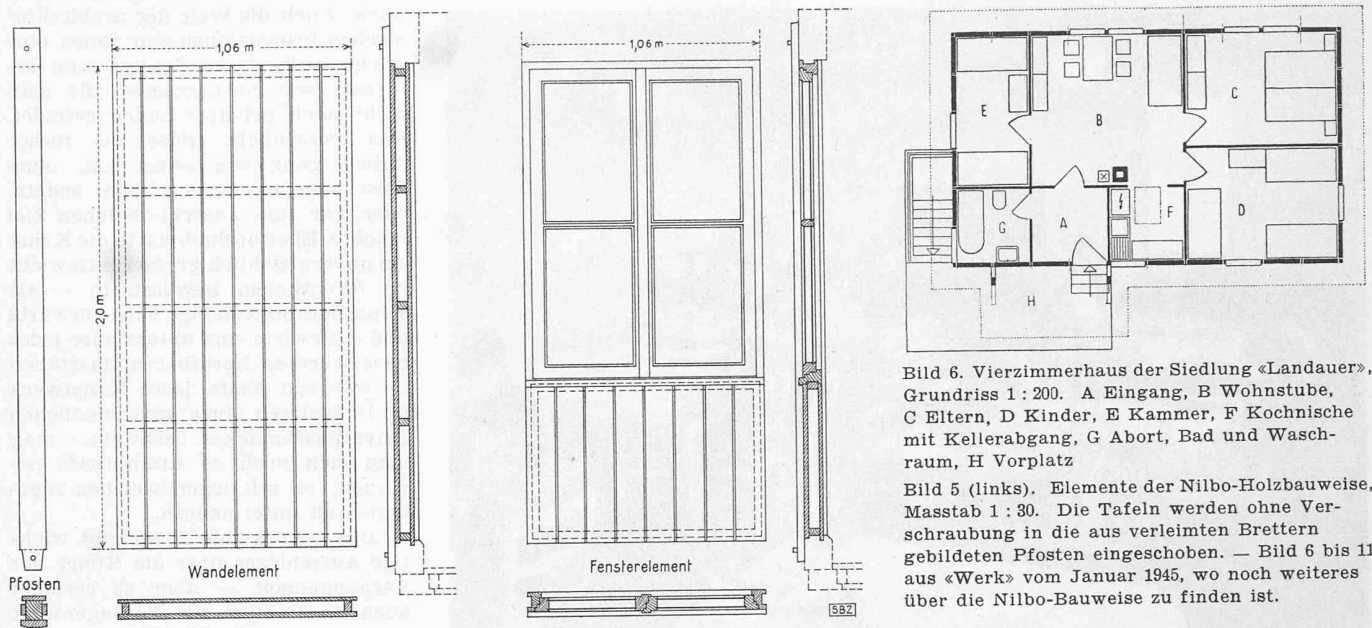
Vierzimmerhaus der Siedlung «Landauer», Grundriss 1 : 200. A Eingang, B Wohnstube, C Eltern, D Kinder, E Kammer, F Kochnische mit Kellerabgang, G Abort, Bad und Waschraum, H Vorplatz
